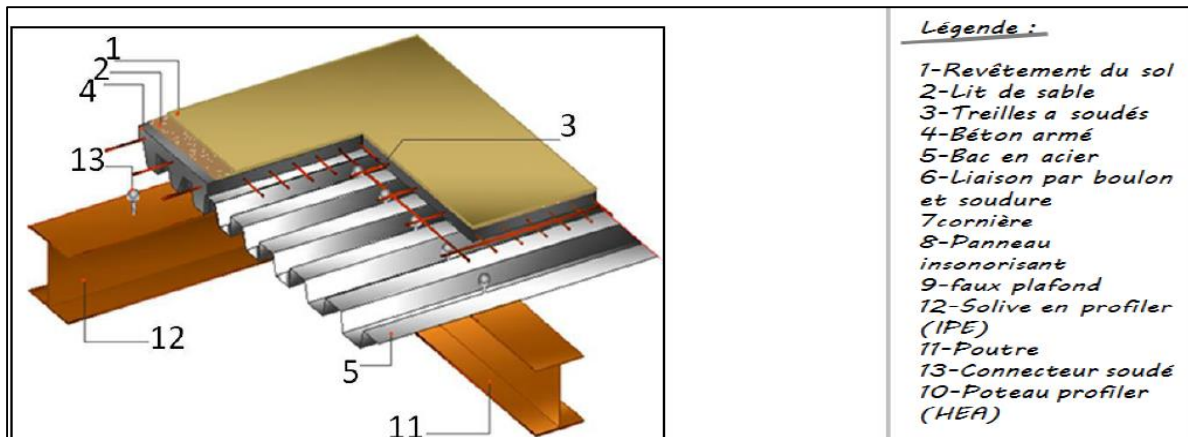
détail d'un plancher collaborant Source : Livre Concevoir et construire en architecture en acier.
